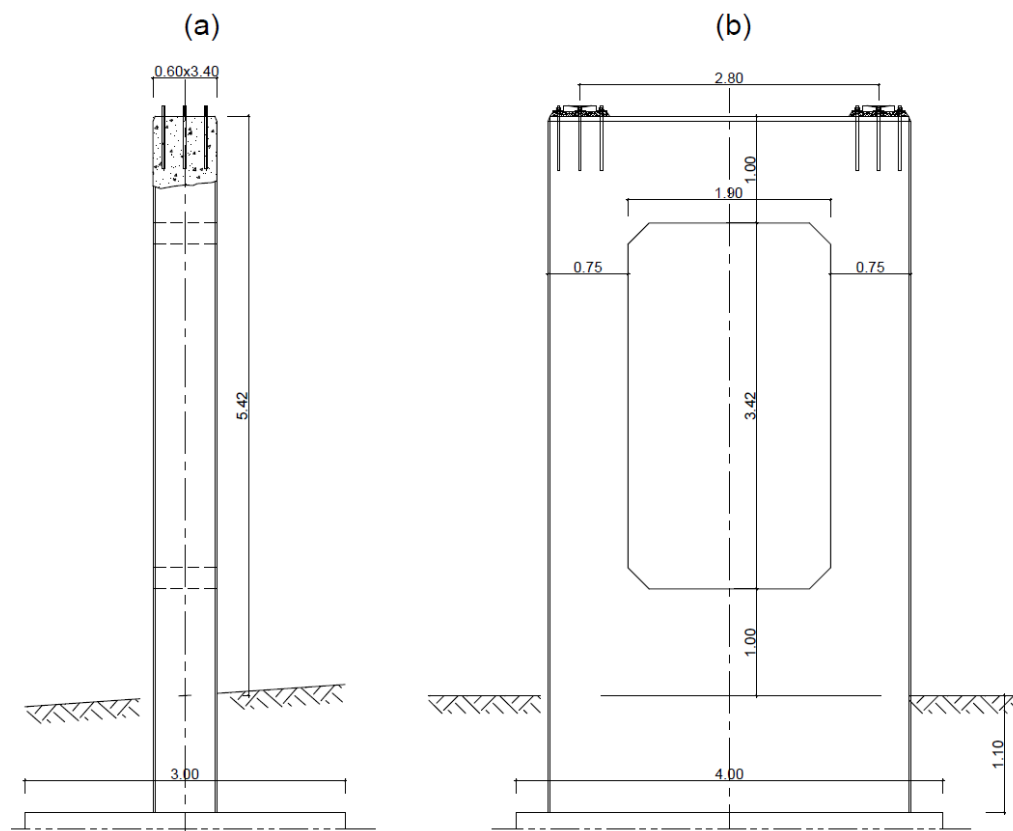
Geometria do pilar P2 (a) Alçado longitudinal; (b) Alçado transversal [2]
